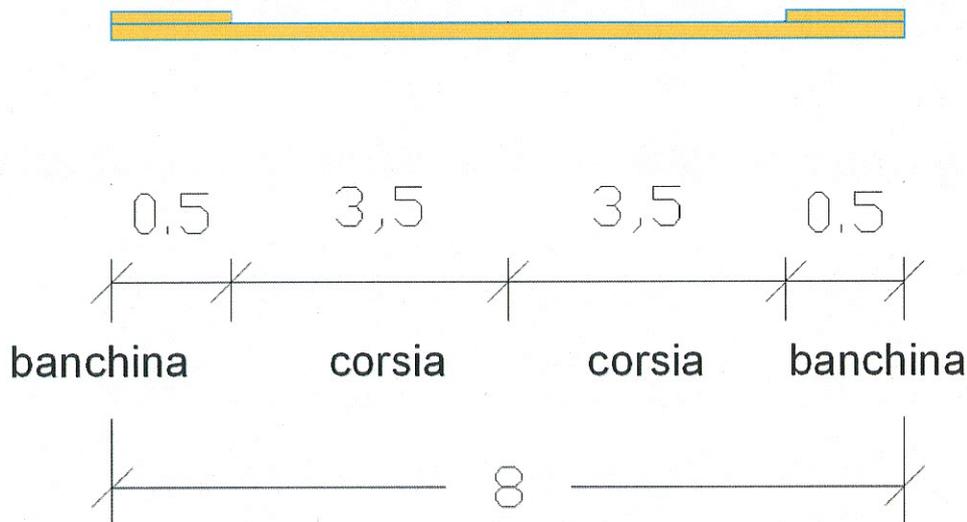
Rappresentazione schematica della sezione trasversale tipo
